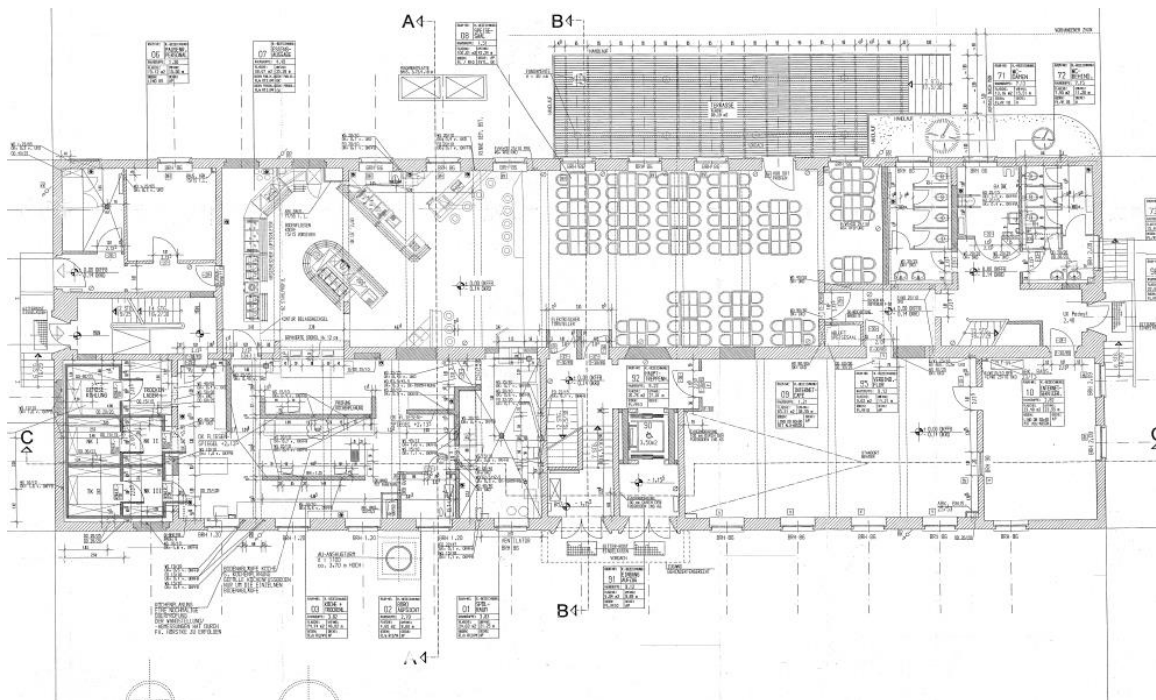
Grundrissplan EG, Gebäude FME
